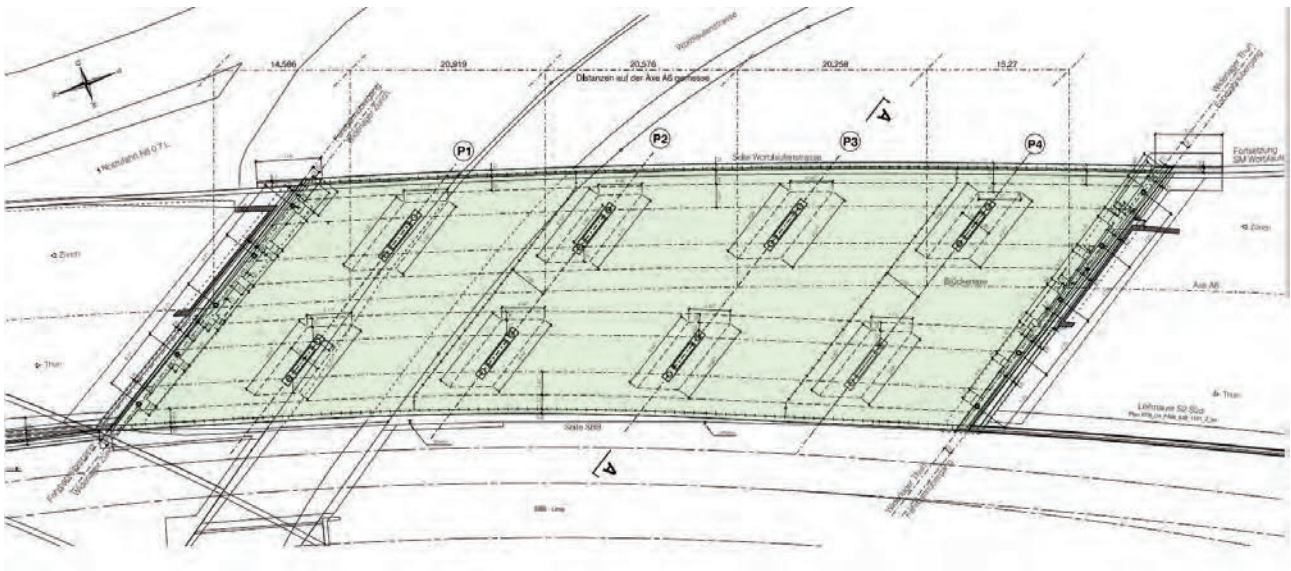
S 02 Brücke Worblaufenstrasse, Grundriss
